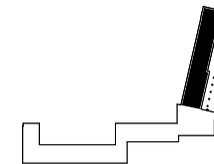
Bauteil D. Erdgeschosszone straßenseitig
